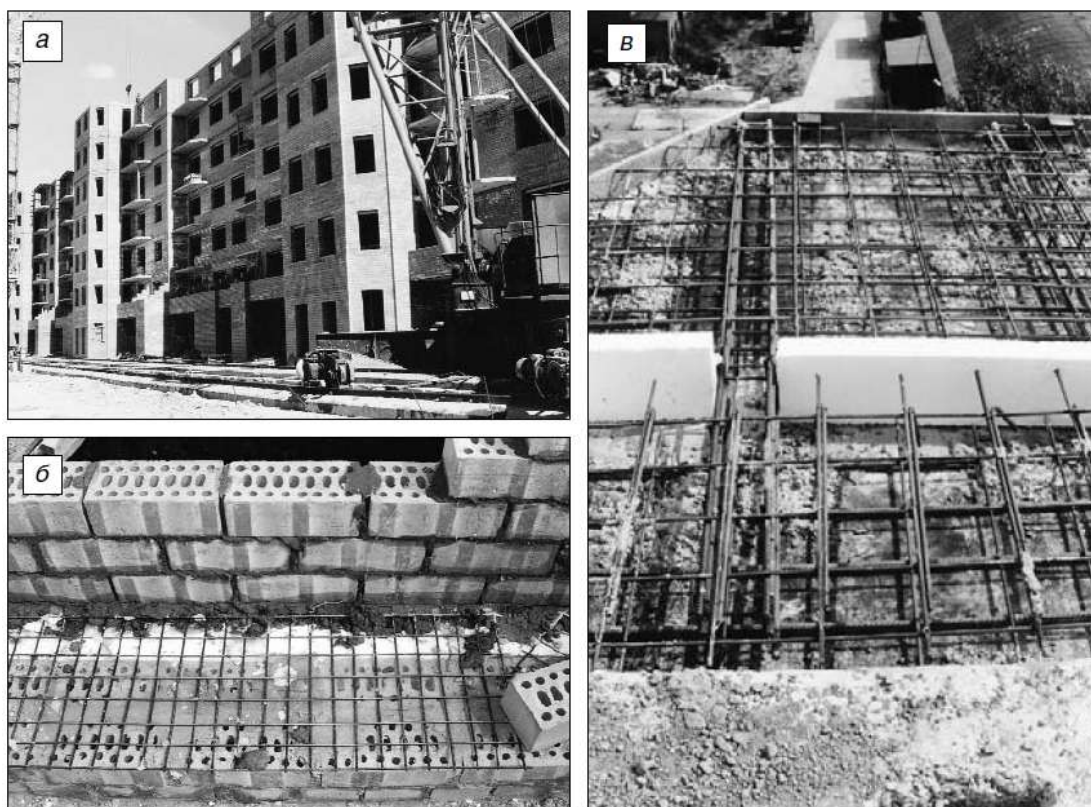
а, б, в. Строительство 10-этажного жилого дома с наружными стенами из многослойной кладки в г. Красногорске Московской области, 1999
